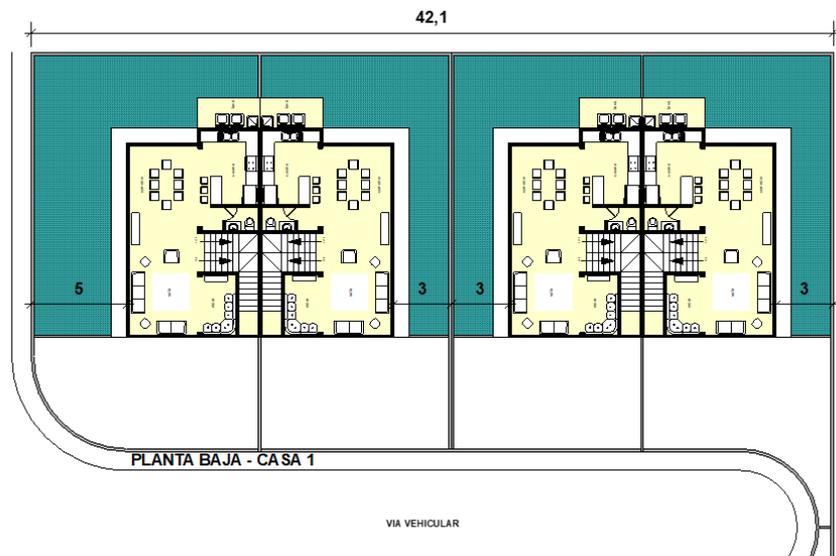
Plano 3 Planta baja casa tipo I. Fuente: Construvicor Cia. Ltda.
